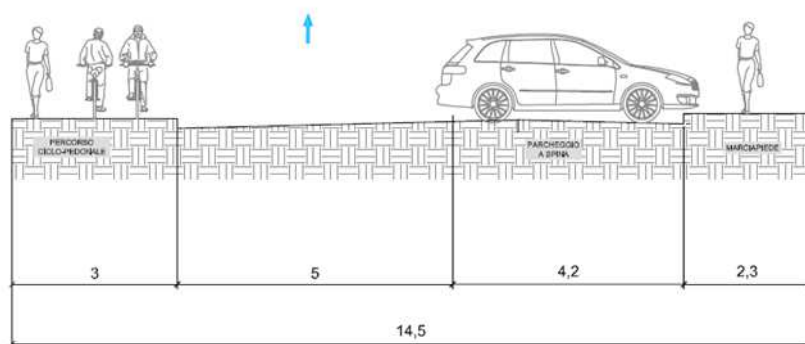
Sezione tipo Via Siena – stato di progetto (1)
